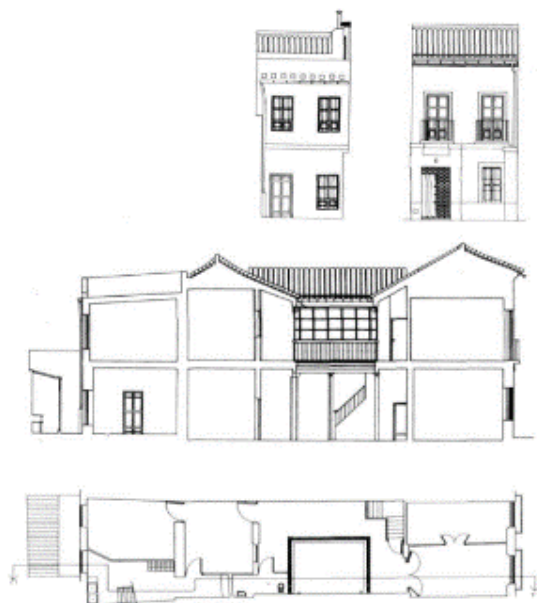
(à esquerda topo) - Fachada, Corte e planta da casa da rua Butrón (s/ data), nº9, Sevilla, Espanha.
